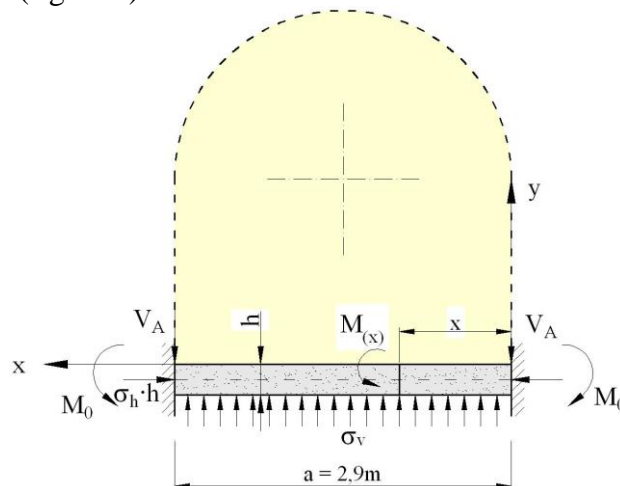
Schema modelului analitic de calcul al stabilității radierului, ce are la bază teoria încovoierei cilindrice complexe a plăcilor plane
